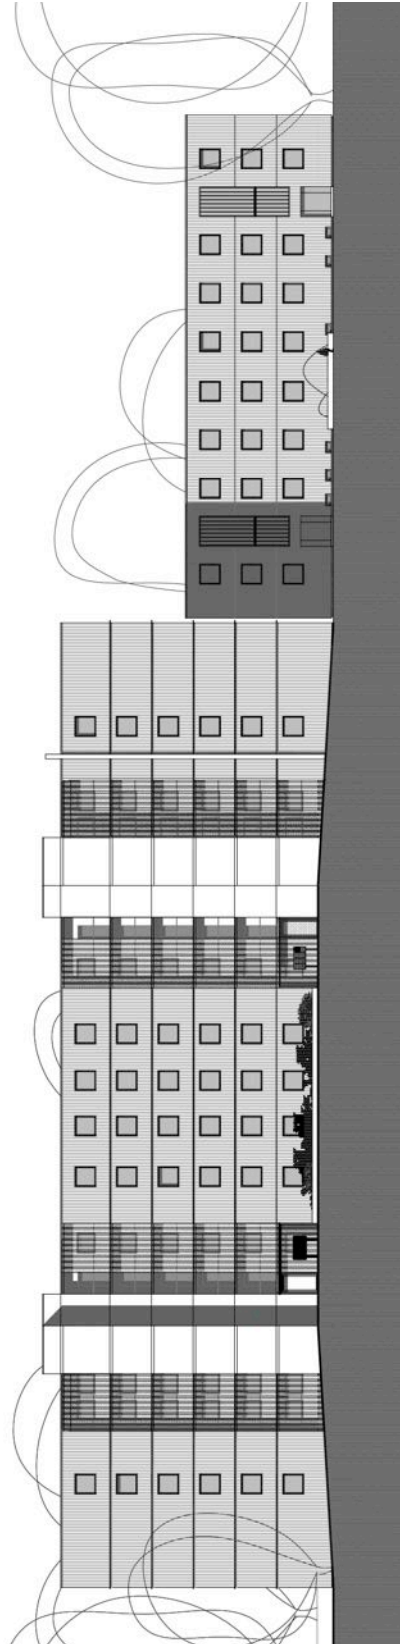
Grüntenstraße 30-36. Elevations (1:500)
